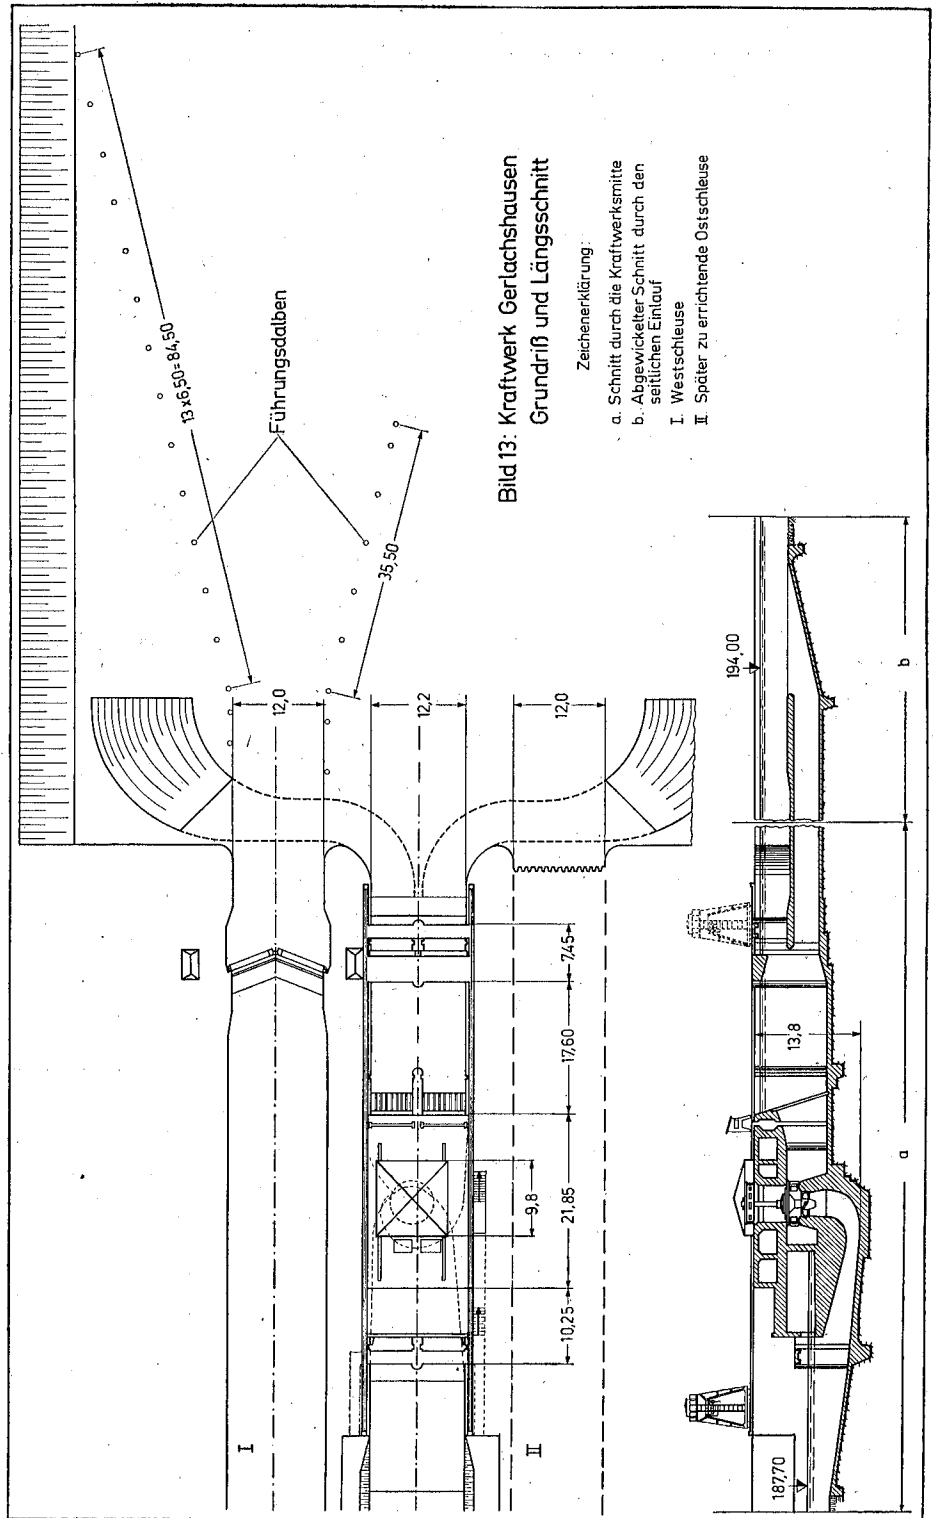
Kraftwerk Gerlachshausen. Grundriß und Längsschnitt.
